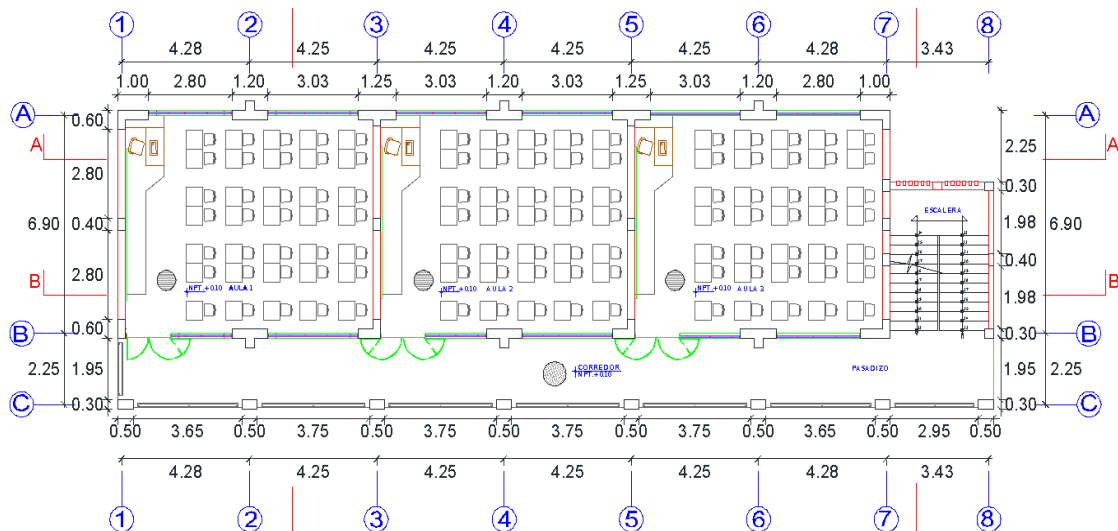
Distribución en planta del primer, segundo y tercer nivel.
